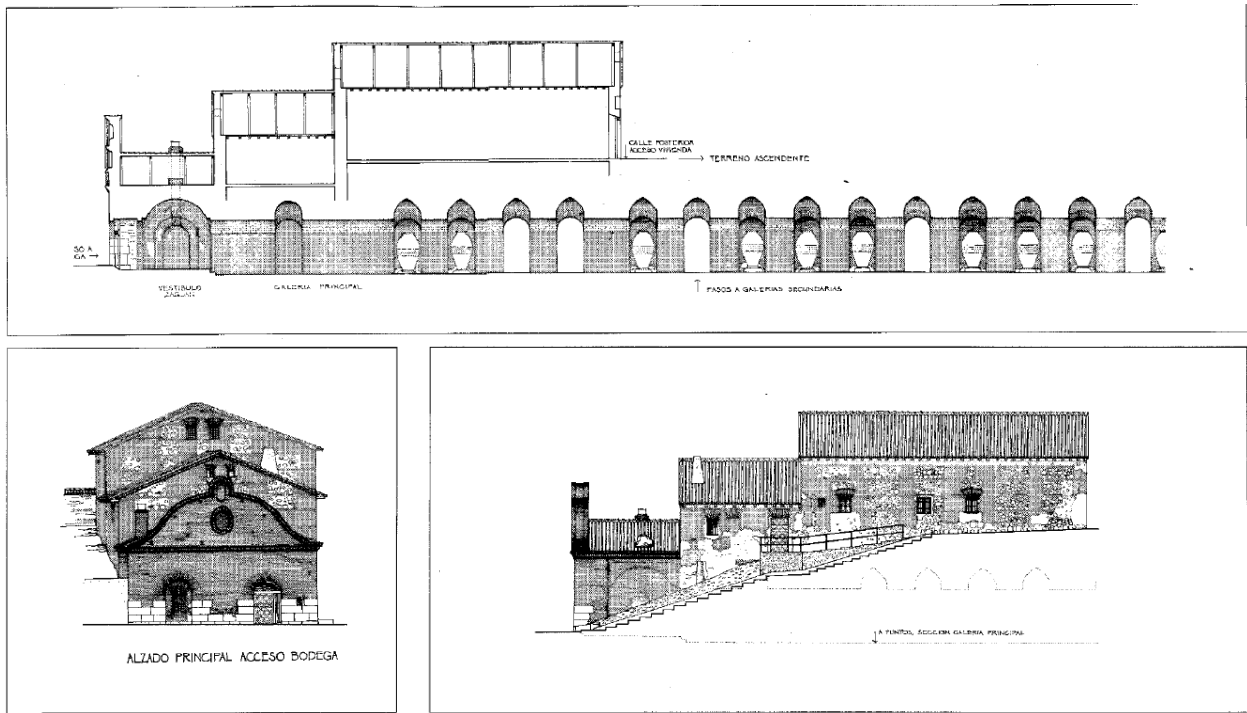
Sección longitudinal, alzado principal y alzado lateral, levantamiento. Fuente: Sandoval, J. (1991).
